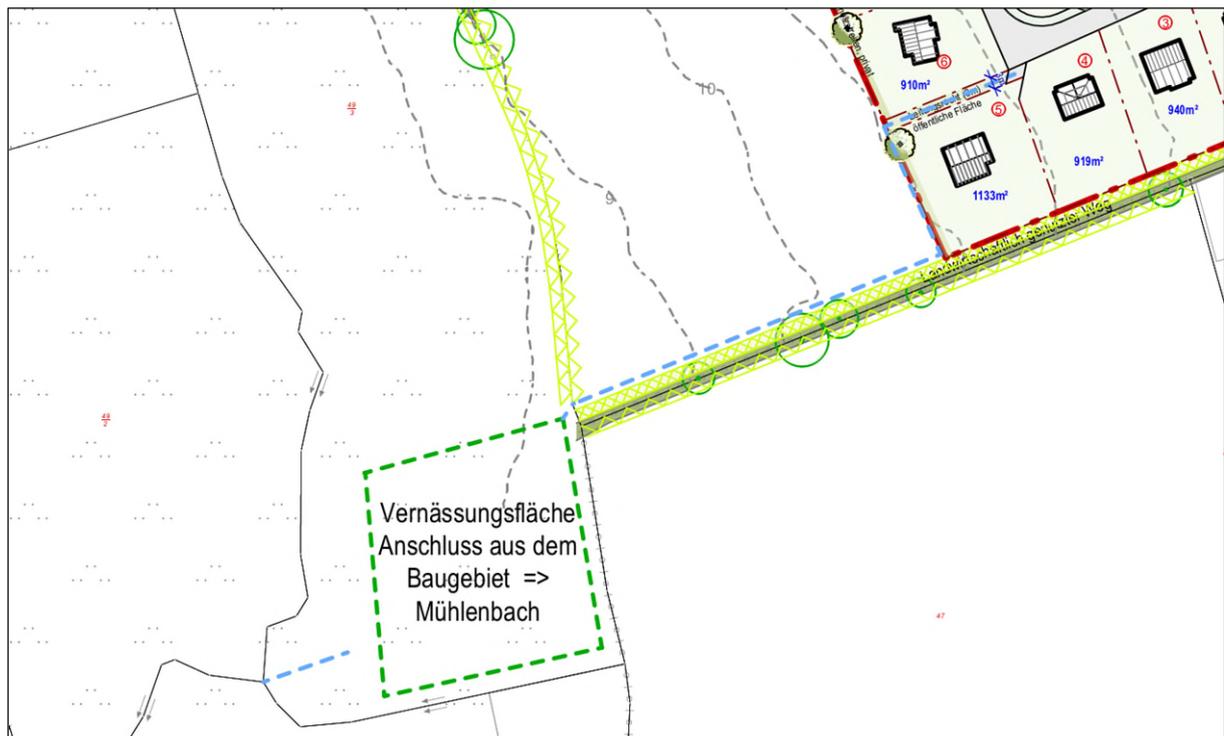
Ableitung des Regenwassers zu einer Rückhalte-/Vernässungsfläche im westlichen Bereich des Plangebiets; Ausschnitt aus dem städtebaulichen Entwurf, ohne Maßstab
